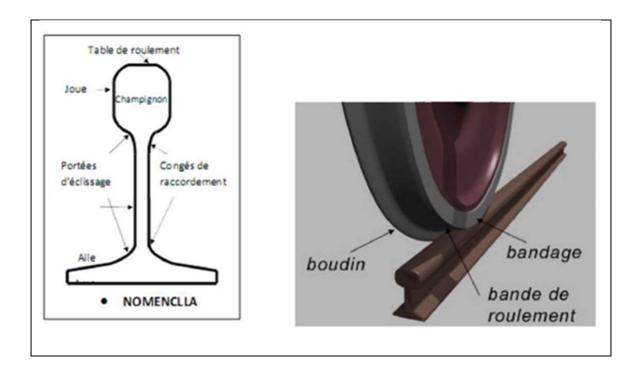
Schéma d'un profil rail II-8-3-5-Les longs rails soudés (LRS)
